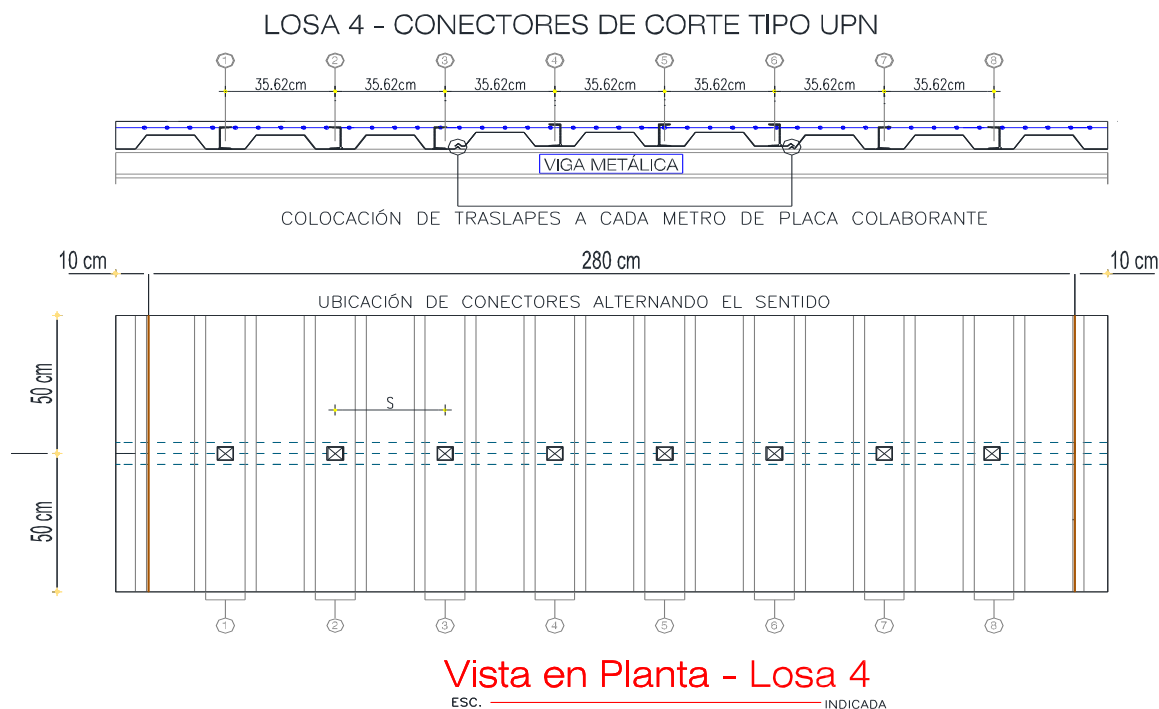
ESTRUCTURA DE LA SECCIÓN COMPUESTA REFERENTE A LA LOSA 4
